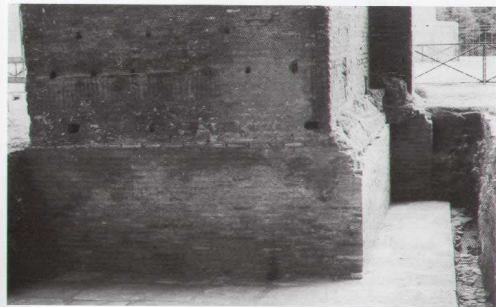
Pilastro del setto trasversale tra la seconda e la terza campata Nord, sovradimensionato sui lati lunghi, e poi rettificato. L'utilizzo di sesquipedali, invece che bipedali, nel piano sommitale delle fondazioni a nastro, può forse farne attribuire la costruzione ad una squadra specifica (cfr. Fig. 5.6).
